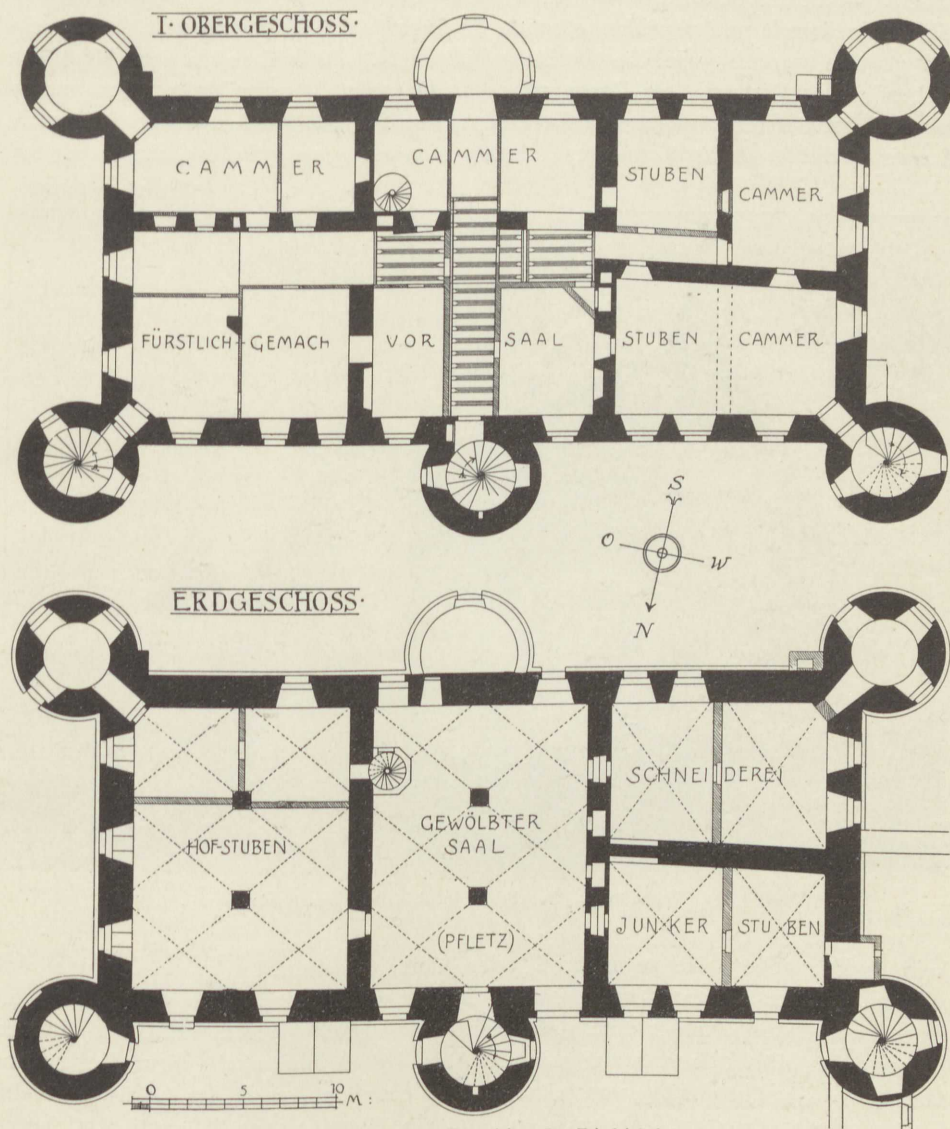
Vohenstrauß. Grundrisse der Friedrichsburg.
